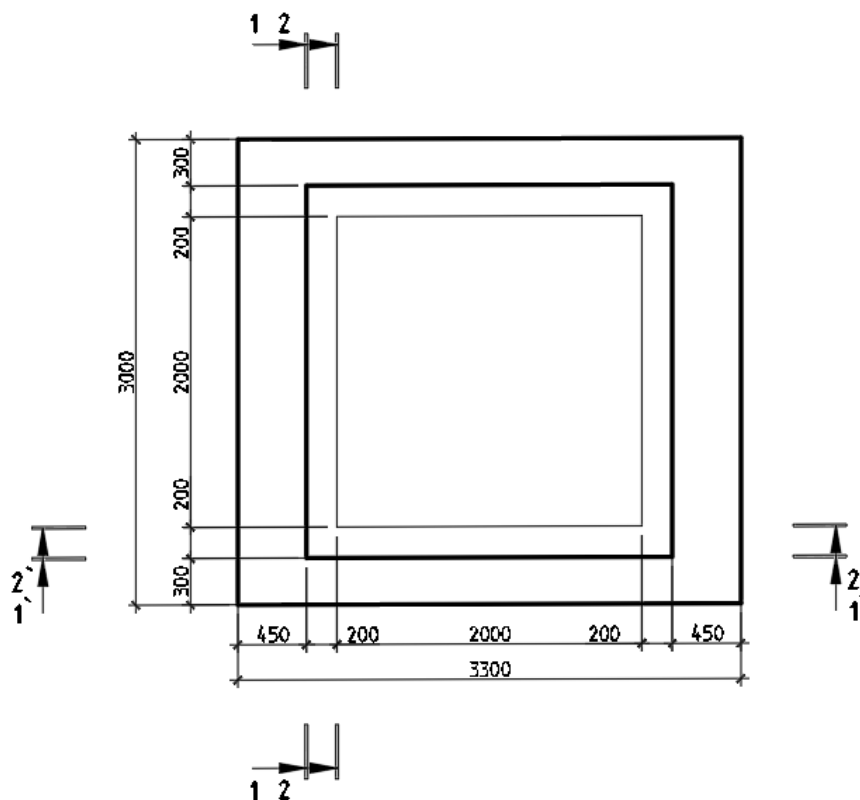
Расчетная схема и сечения при определении арматуры плитной части фундамента
